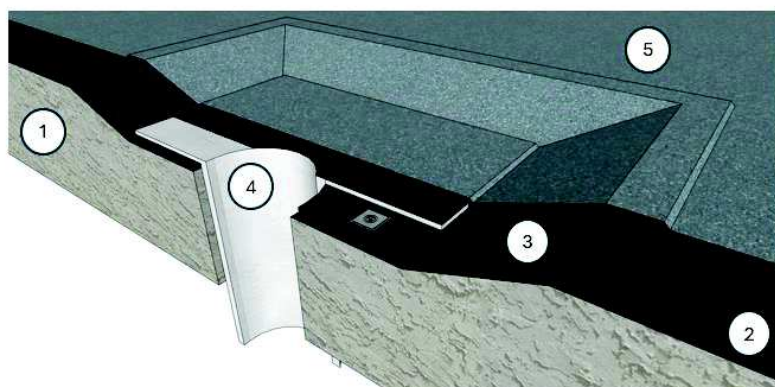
Relevés variante - Soudure à air chaud
